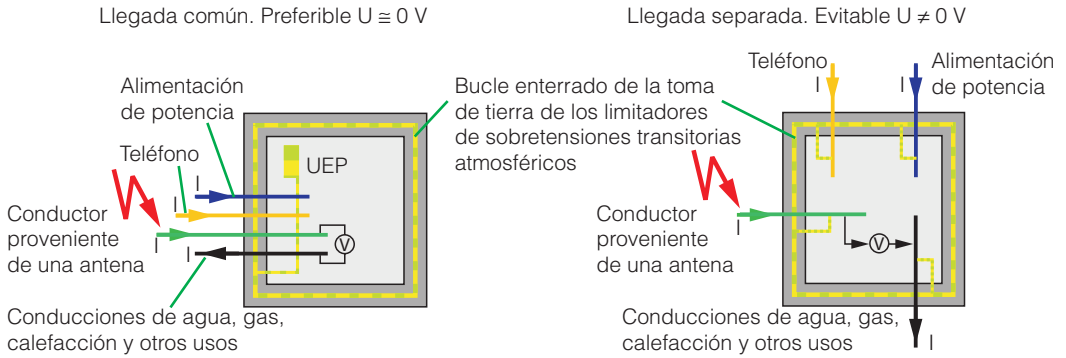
penetración de conducciones metálicas o armadas en un edificio.
